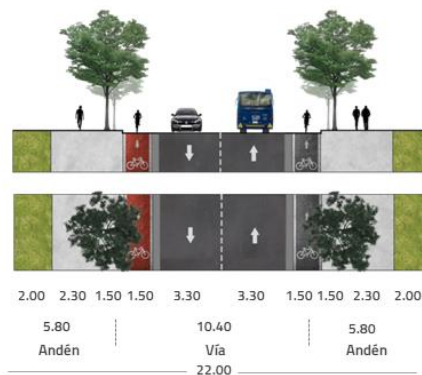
Perfil vial Avenida parque guaymaral sur
